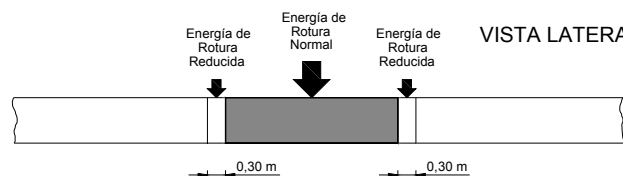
Cortes de protección para evitar roturas inferiores del hormigón sano en la zona perimetral.
